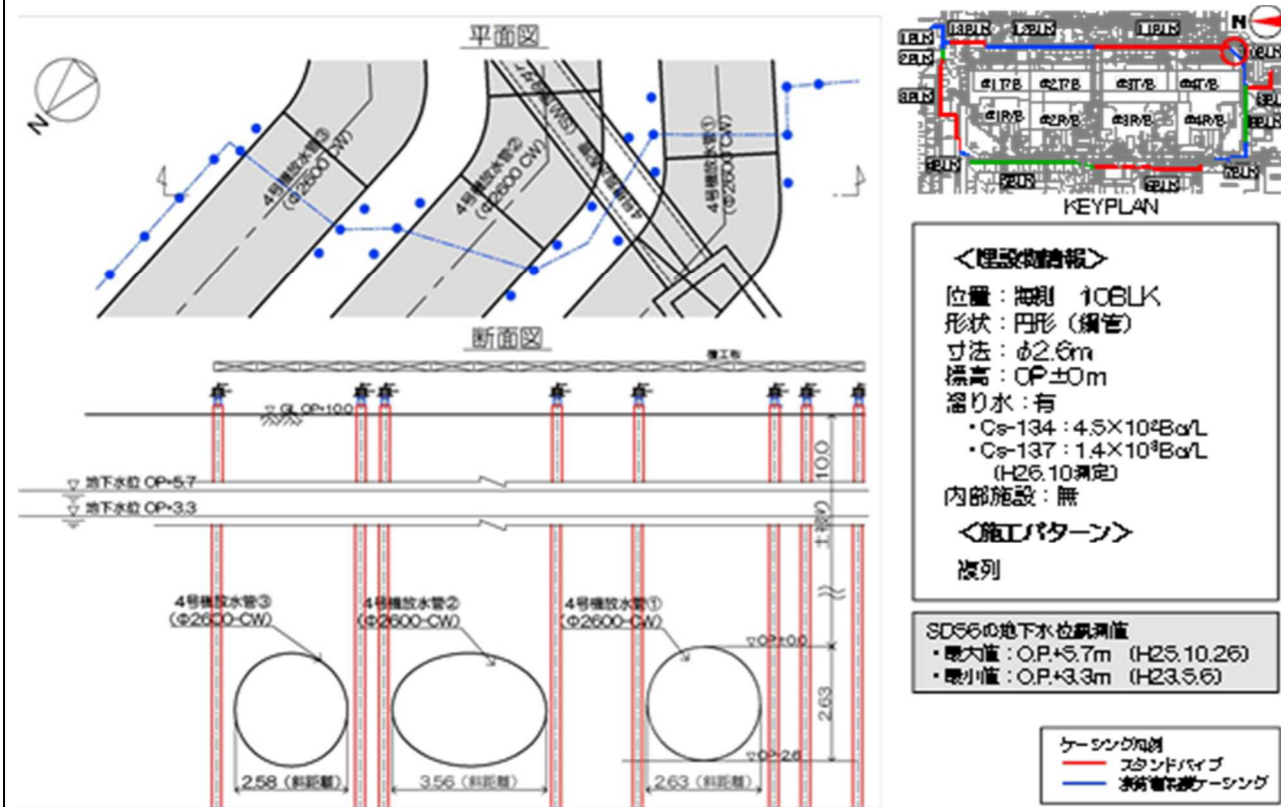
【10-3】4号機放水管①②③ 施工方法 (複列施工)
